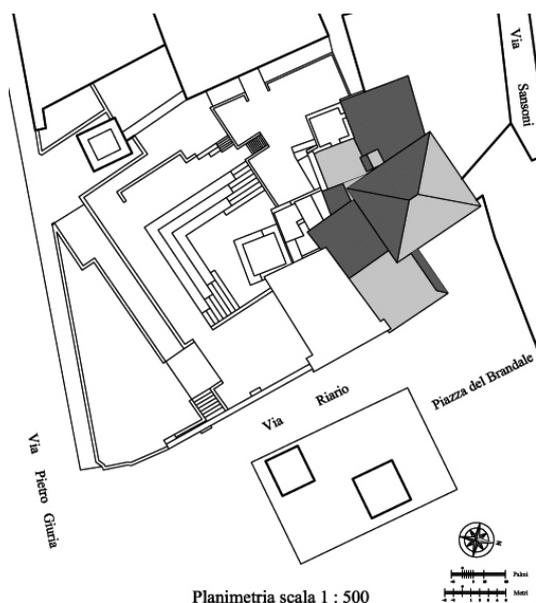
Planimetria generale. Inquadramento complesso di piazza del Brandale a Savona.
